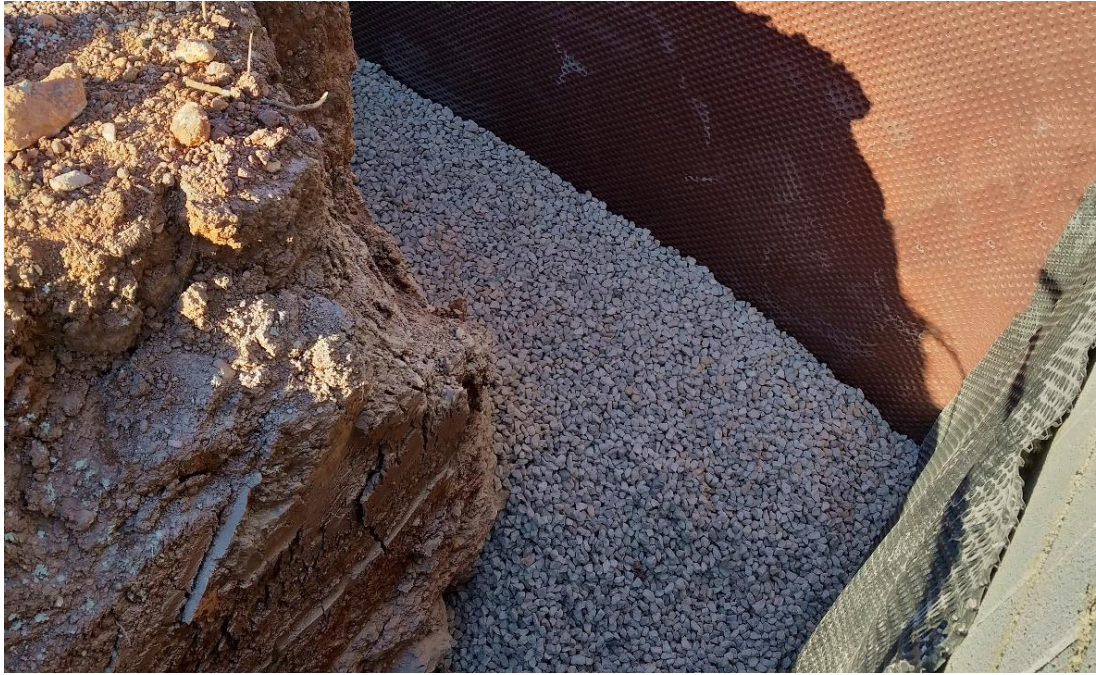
Capa de grava sobre tubo de PVC envuelto con lámina de geotextil. Fuente: elaboración propia.
